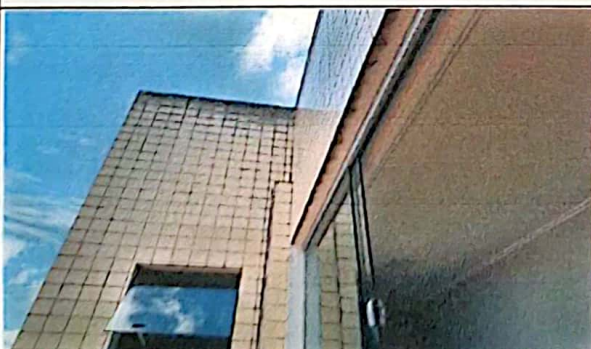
Fachada lateral revestida em pastilhas cerâmicas e vãos de ventilação em vidro.
